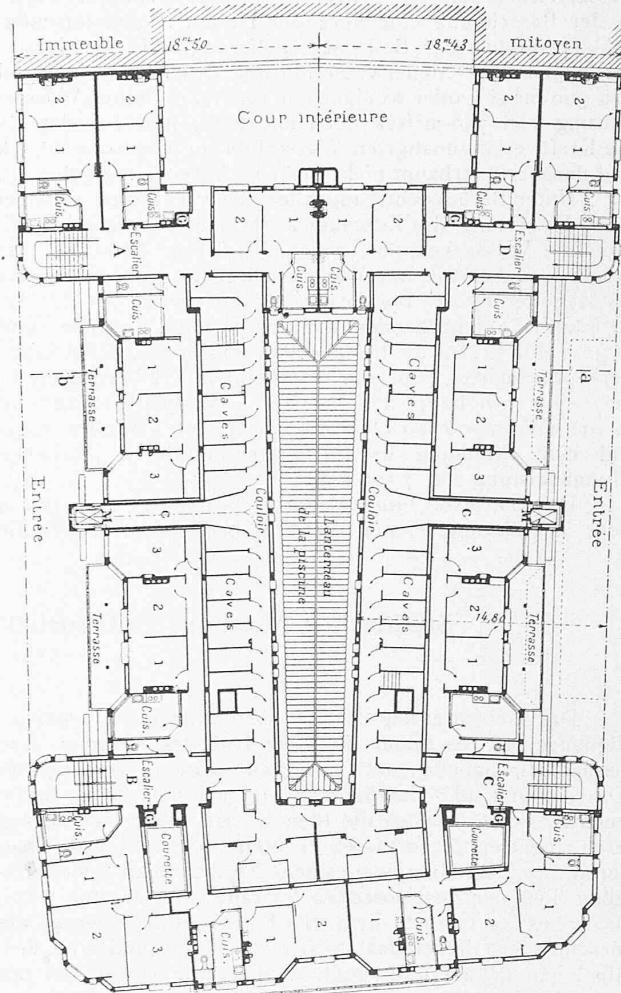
Grundriss. — Masstab 1 : 400.
